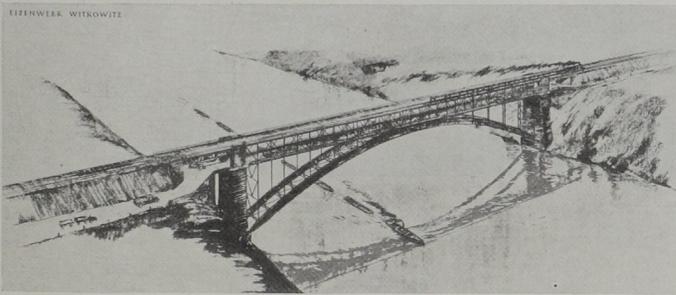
Entwurf einer kombinierten Eisenbahn- und Straßenbrücke über den alten Dnjepr bei Alexandrowsk (Sowjet-Union). Stützweite 224 m. Verfasser Prof. Dr.-Ing. A. Hawranek
